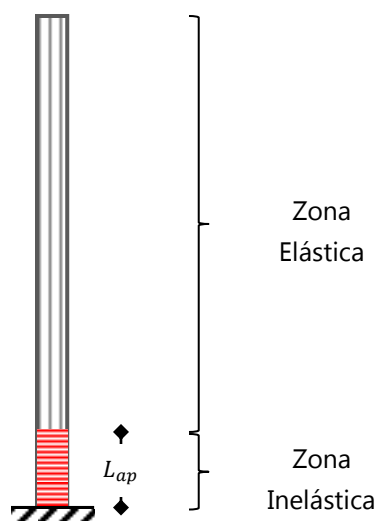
a Esquema de pilas modeladas mediante dos elementos.
